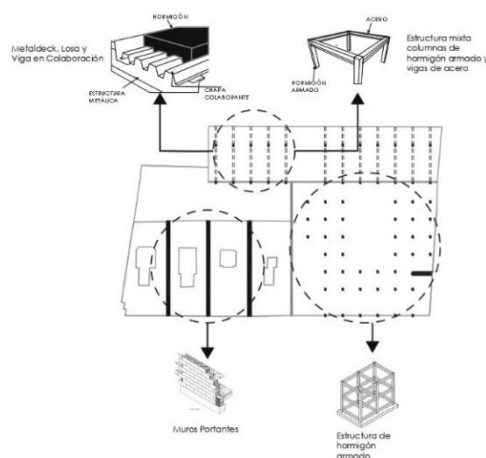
Diagrama de estructura. Elaboración propia, 2024.
